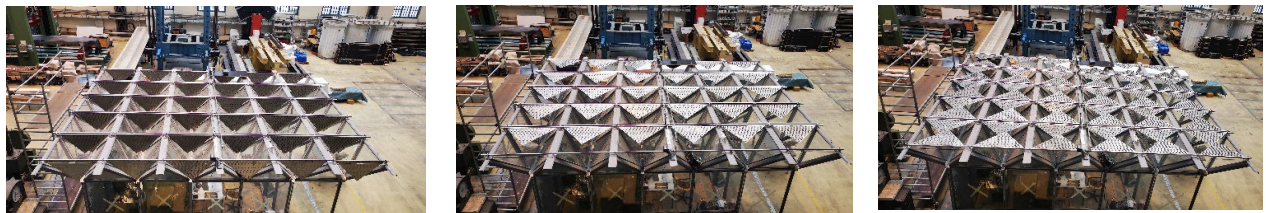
Aufbau des fertigen Mock-Ups mit wandelbaren Dachverschattungselementen, Versuchshalle TU Berlin
